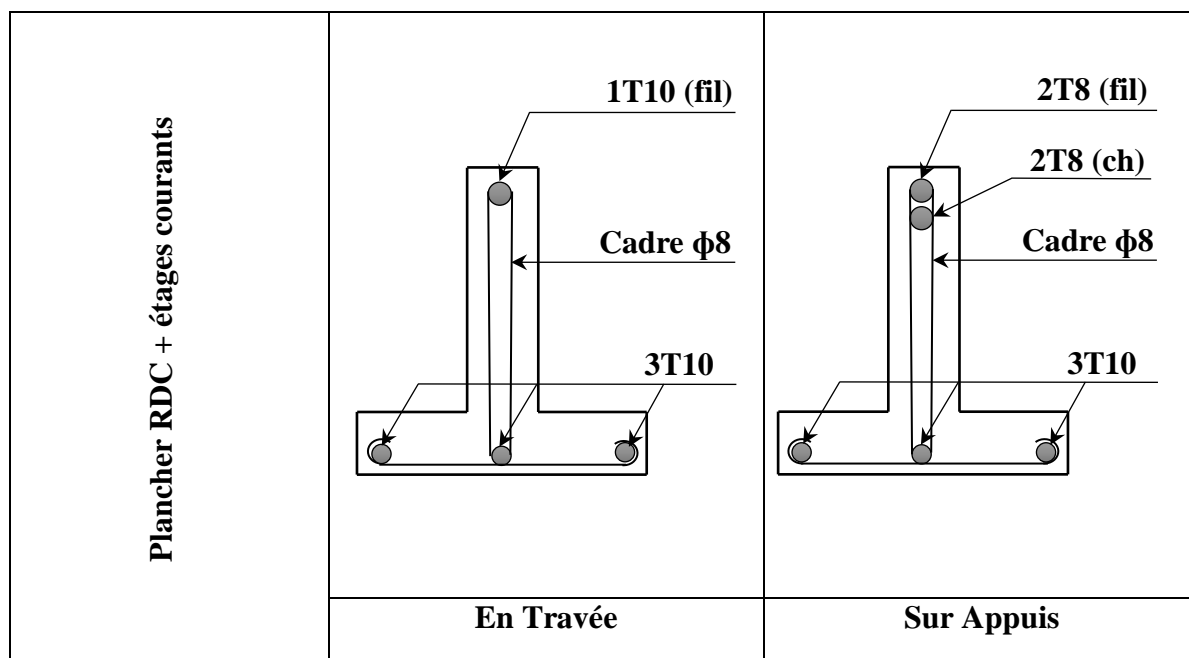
Dessin de ferrailage des poutrelles des étages courants et RDC.
